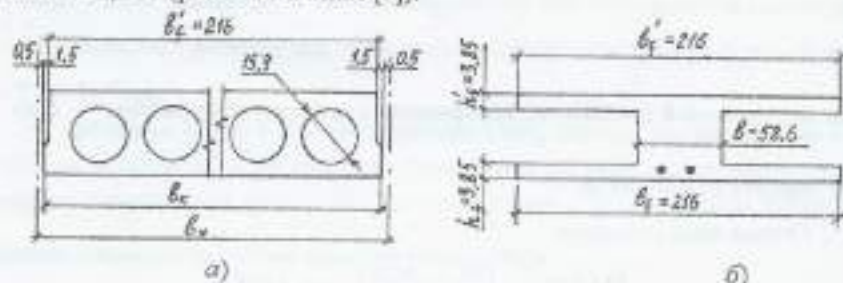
Конструкция многопустотной плиты перекрытия:
